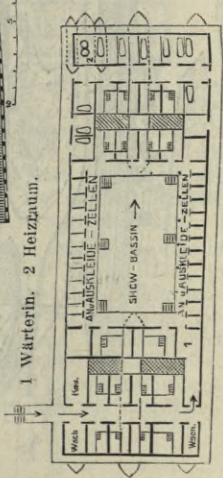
Grundriss des Damen-Badeschiffs.
